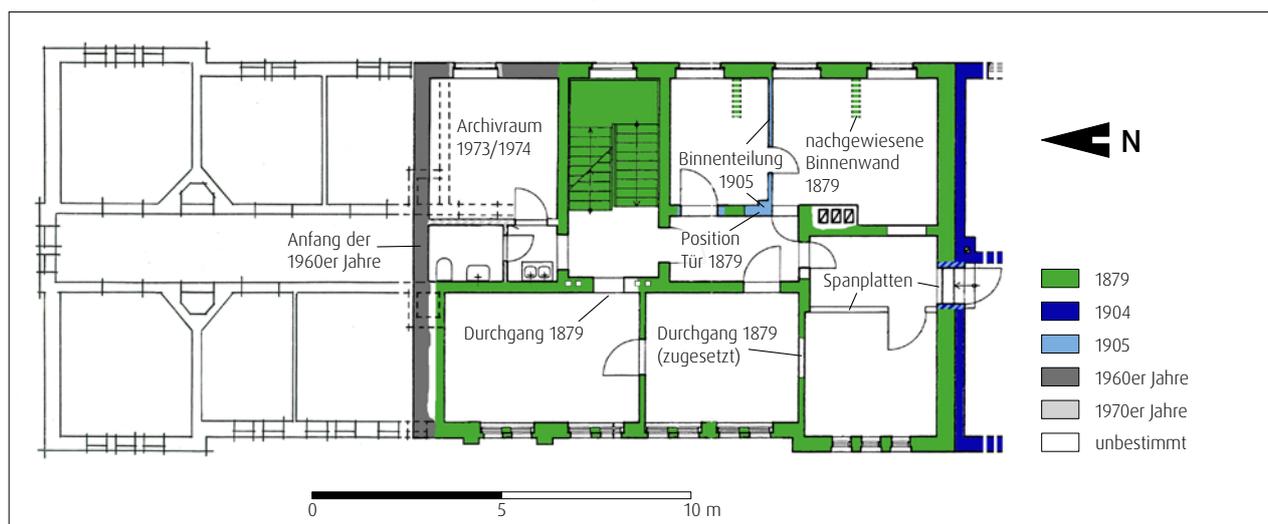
Greifswald, Baderstraße 24. Baualterskartierung für den südlichen Obergeschossbereich des ehemaligen Polizeifängnisses und Grundriss des Nordteils nach einer Darstellung von 1914. Zeichnung: D. Brandt (2017). Plangrundlage: Architekturbüro Saalfeld (1995) / Bauamtsakte: Baderstraße 24
